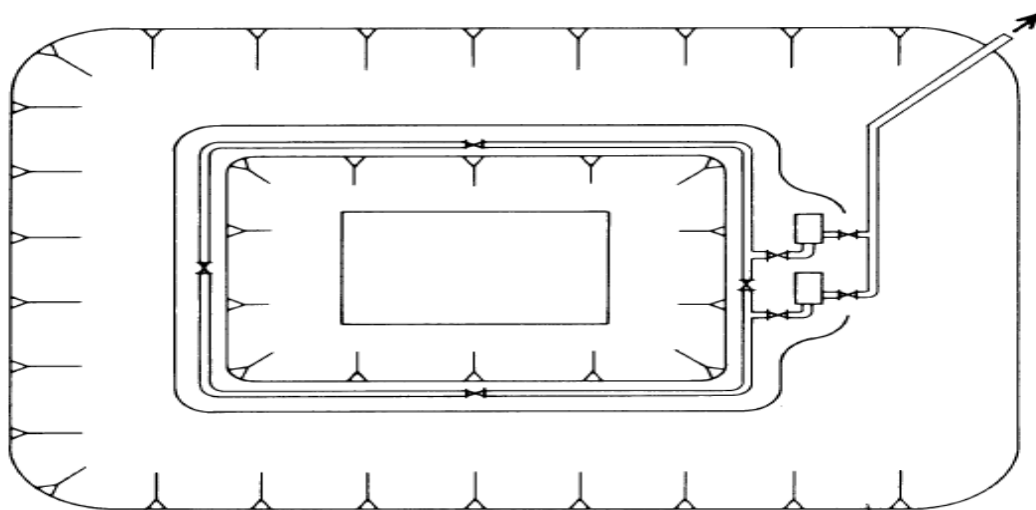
Instalação em planta do sistema de rebaixamento wellpoint (Powers, 2007)
